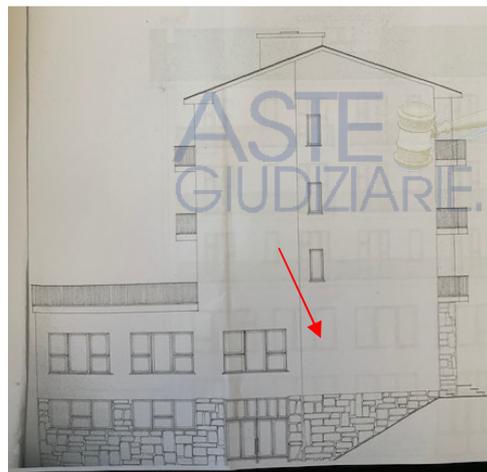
Estratto prospetto laterale Licenza Edilizia n.341/1971
